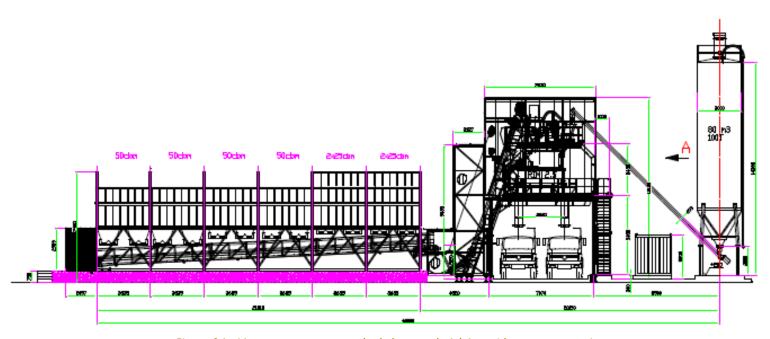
Vue en coupe transversale de la centrale à béton (document LIEBHERR)
